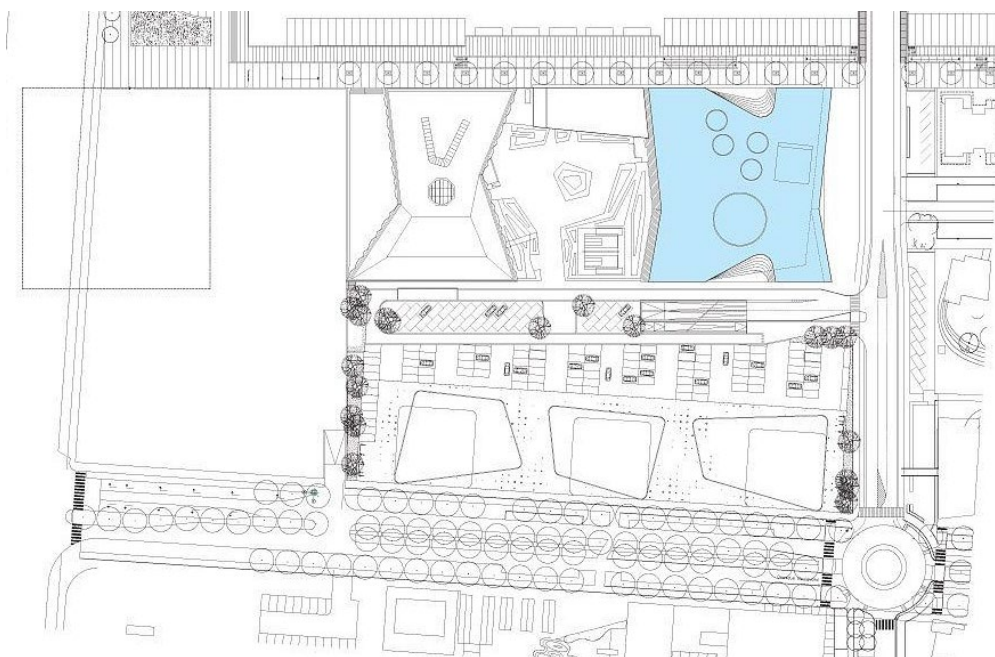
Схема генерального плану *Saxo Bank* Данія
